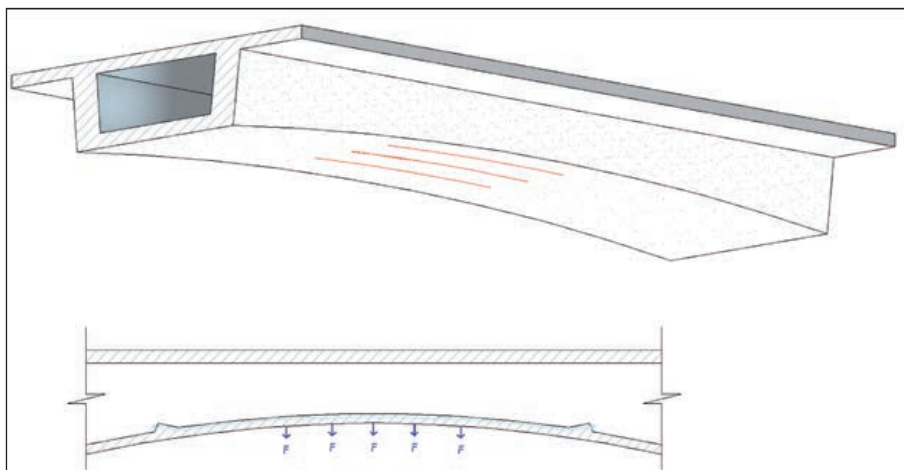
FISURAS DEBIDAS A TENDONES CURVOS EN LA LOSA INFERIOR DE PIEZAS DE SECCIÓN CAJÓN Y CANTO VARIABLE.
